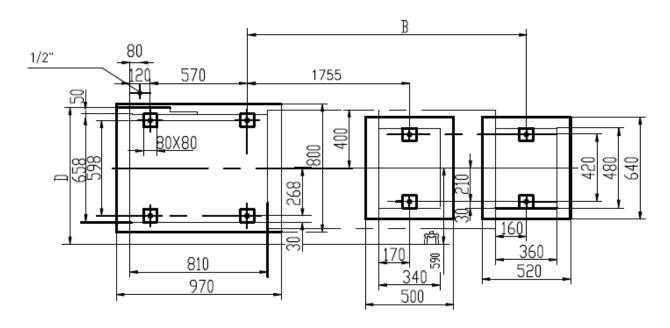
План фундамента для моделей с РМЦ 3000 мм.
